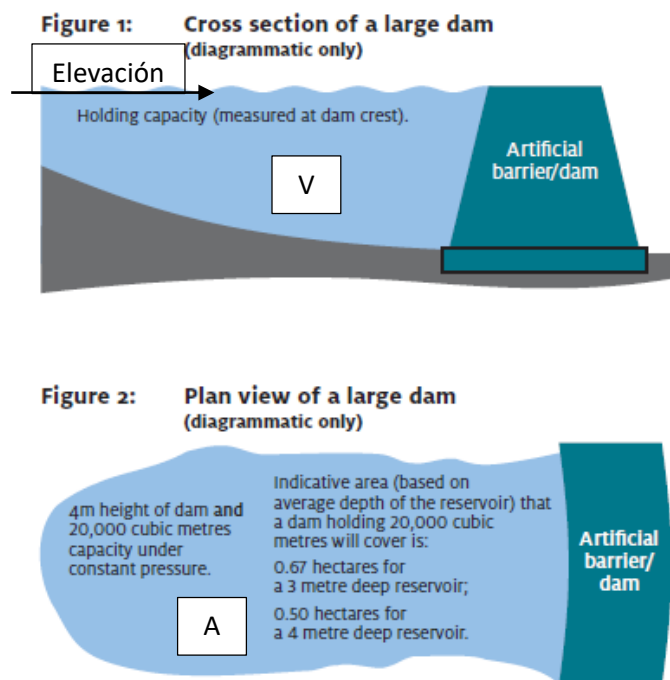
Volumen, área y elevación en un embalse. Arriba: vista perfil, abajo: vista en planta.²
